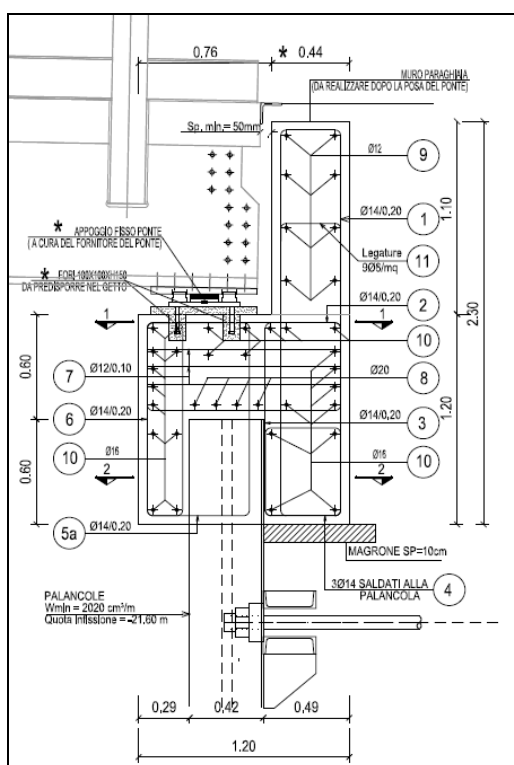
Sezione trave frontale in c.a. di appoggio ponte
